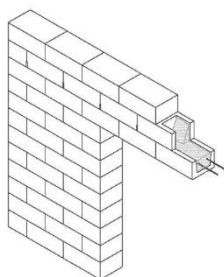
formazione dell'architrave di porta con blocco a canaletta riempito in calcestruzzo armato
